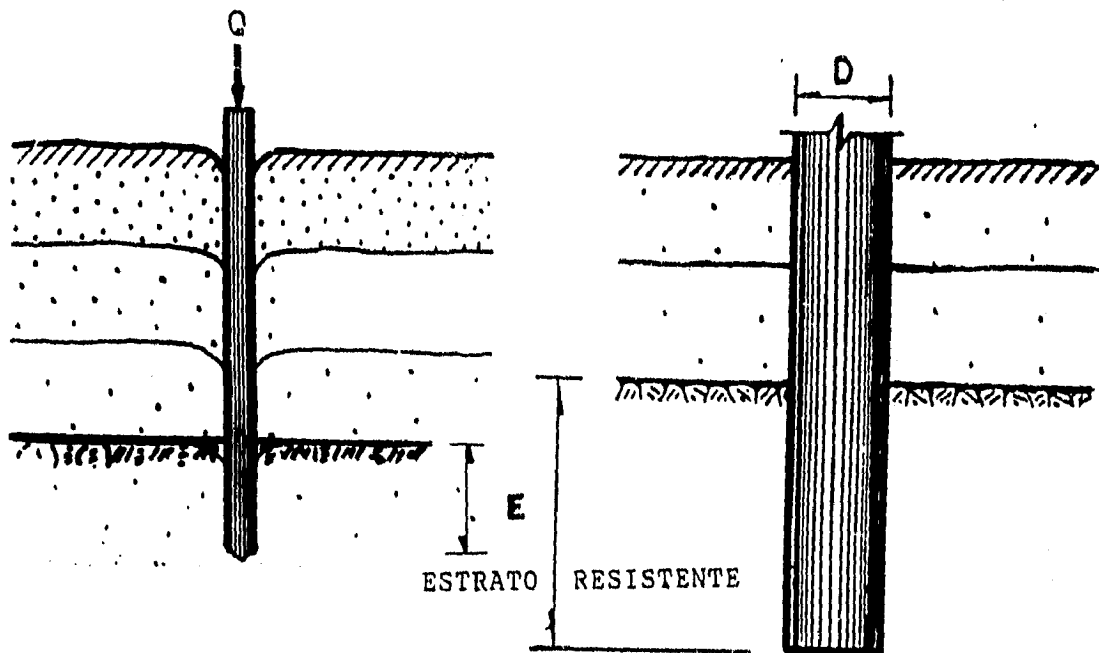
PILOTES Y PILAS EMPOTRADOS EN EL ESTRATO RESISTENTE
